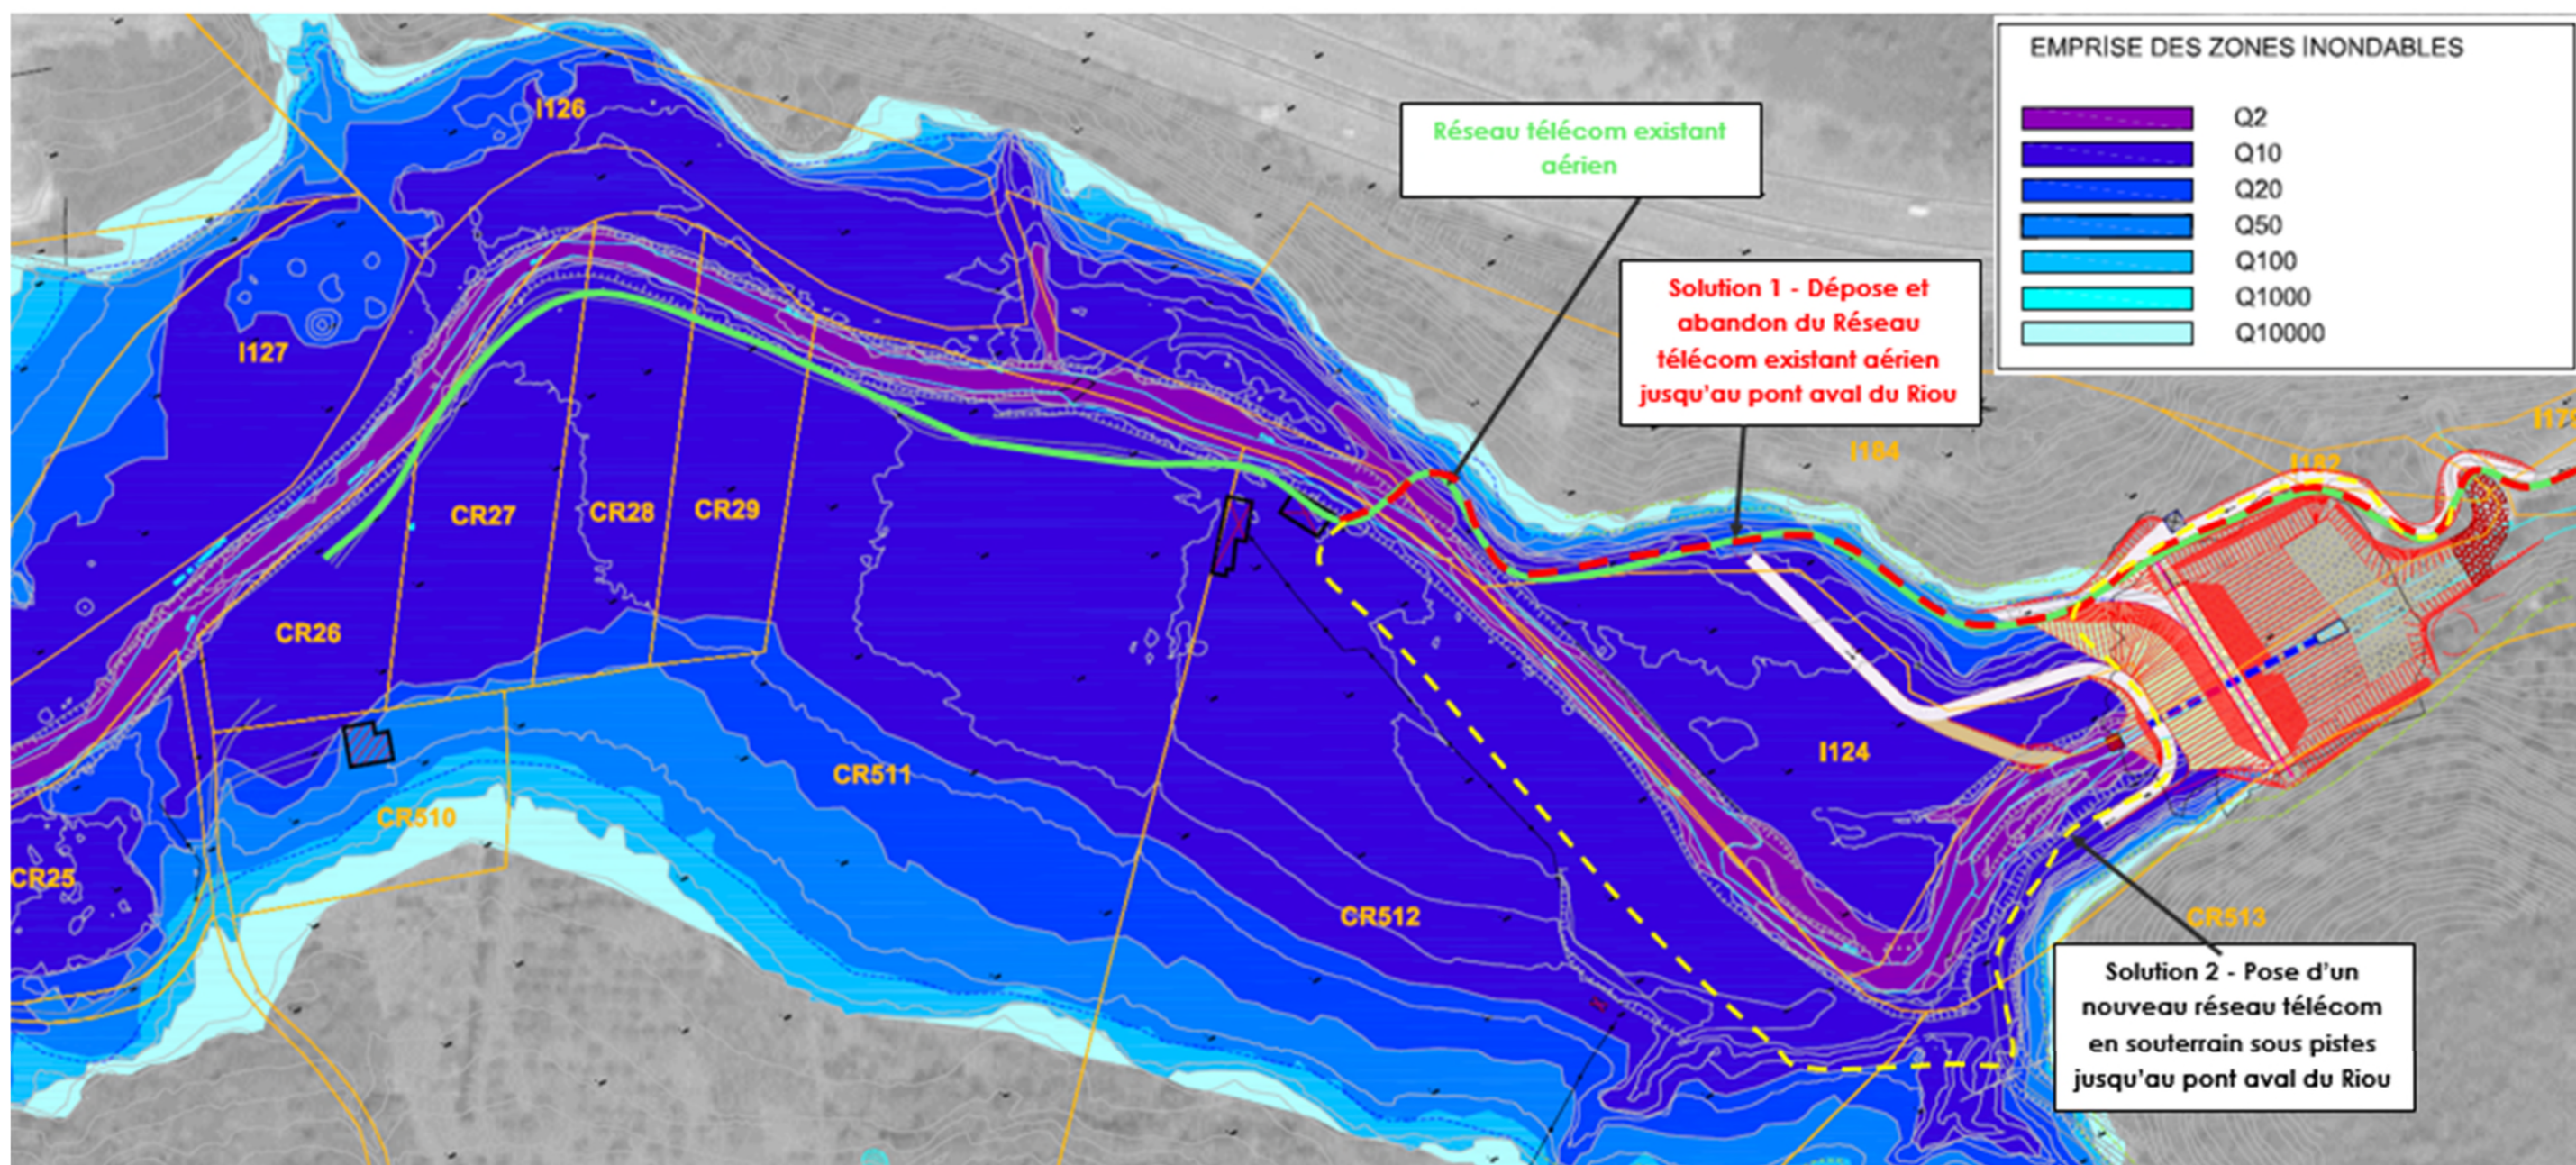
Plan de principe de dévoiement du réseau télécom aérien existant sur fond de plan n°2 de l'AVP
